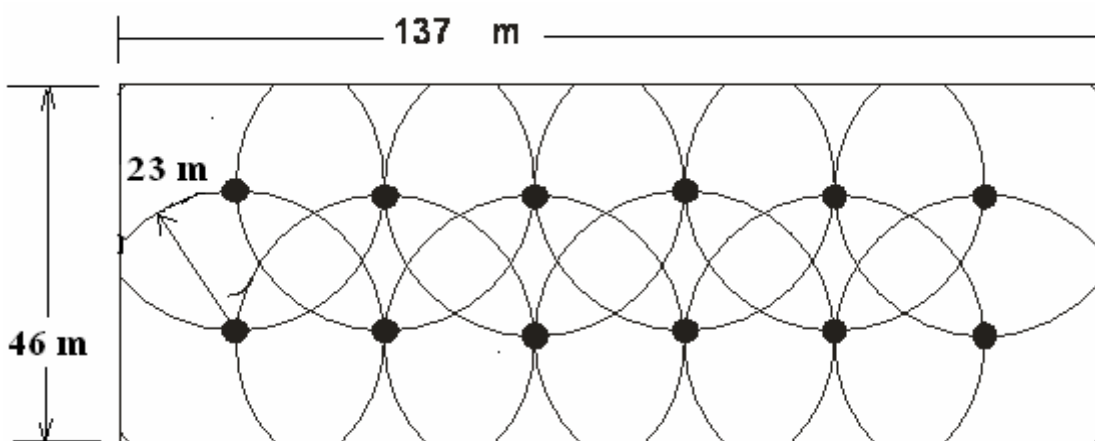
Requerimiento de distancia de recorrido y distribución de extintores instalados en columnas del edificio o paredes interiores
